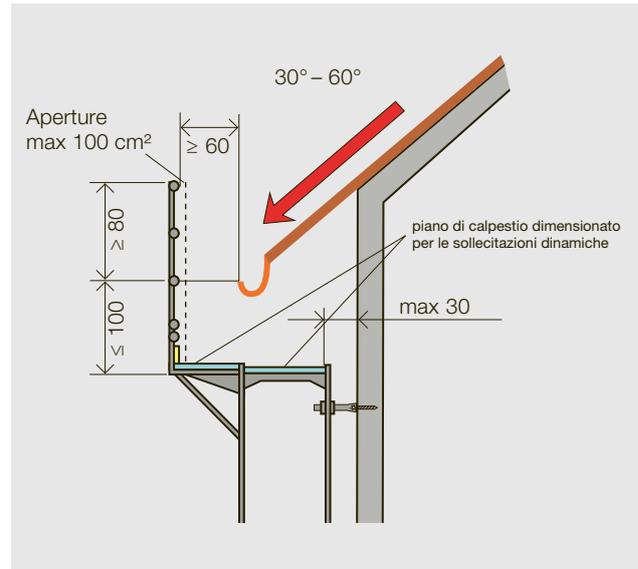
ponte da lattoniere con parete di protezione da copritetto
